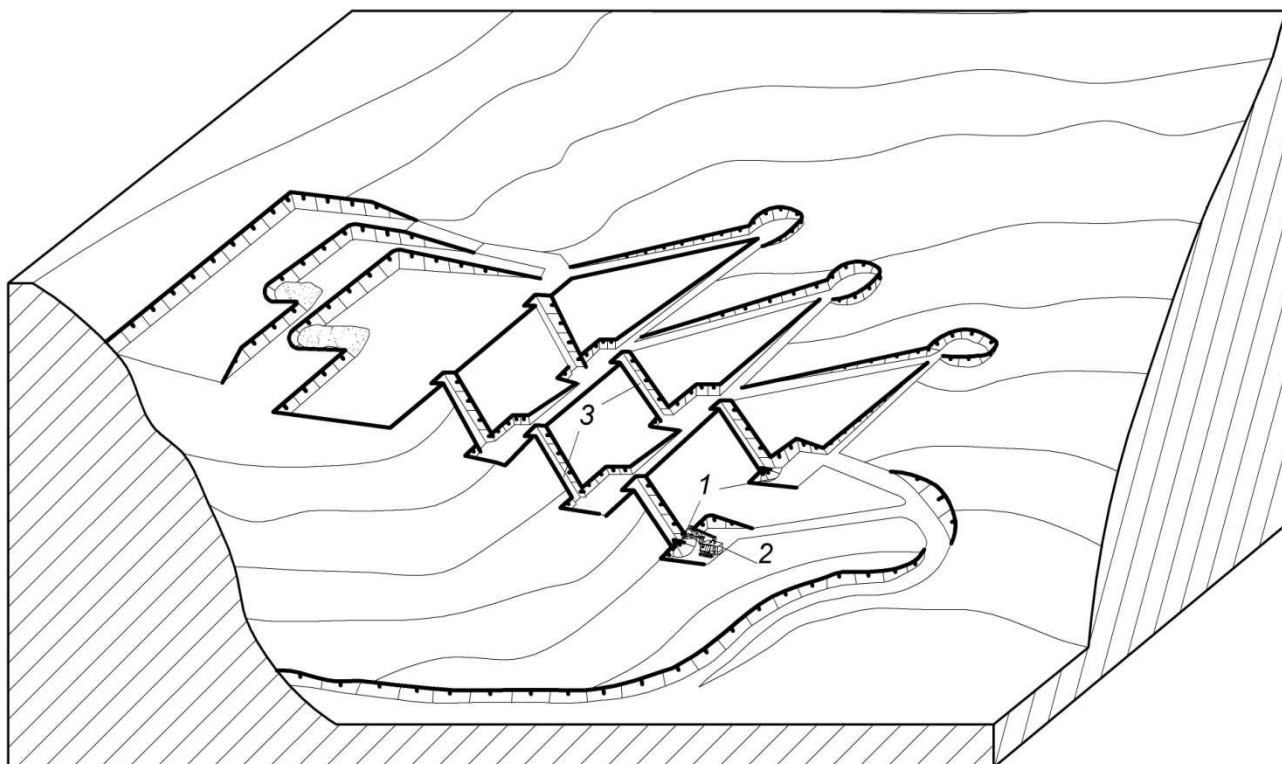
Схема розкриття родовища із застосуванням рудоската: 1 – перевантажувальний пункт; 2 – рудоскат; 3 – екскаватор
